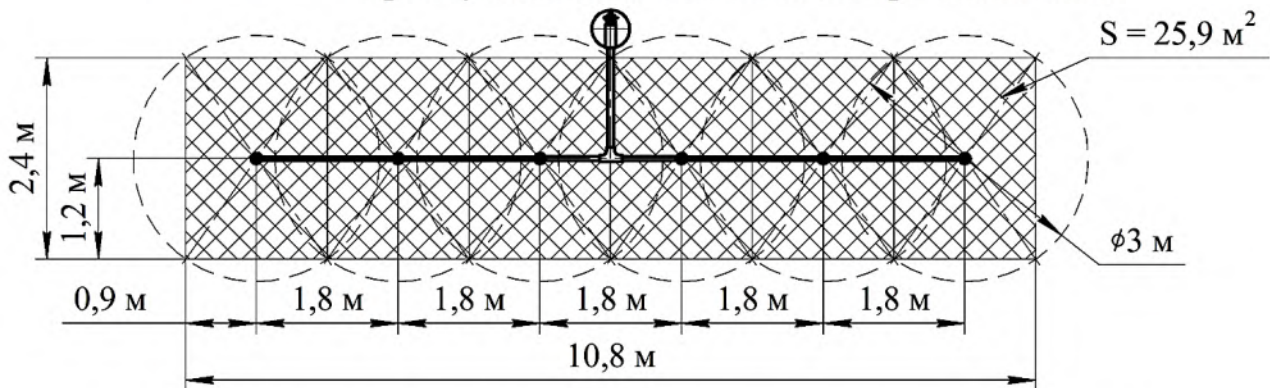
Вариант трубной разводки по вписанным прямоугольникам на 6 насадков-распылителей
